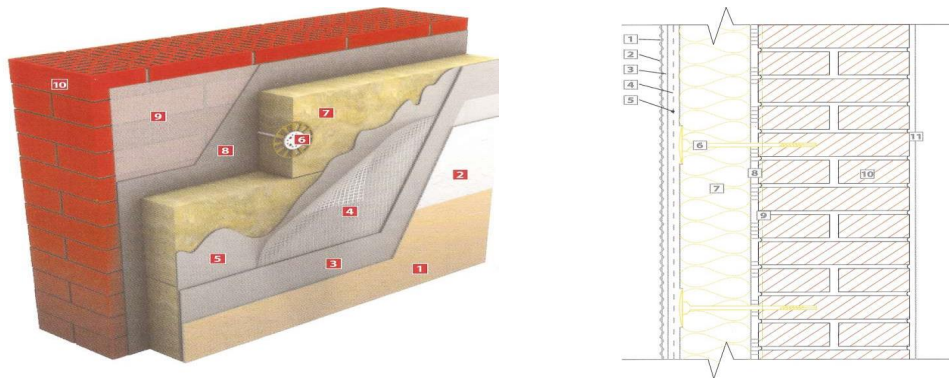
Система штукатурного фасаду з матеріалом-утеплювачем по кам'яній основі: 1 – фасадна фарба (за необхідністю); 2 – декоративна штукатурка; 3 – кварцева ґрунтівка; 4 – склотканева сітка; 5 – базовий армуючий шар; 6 – тарільчастий фасадний анкер; 7 – утеплювач; 8 – клей для теплоізоляційних робіт; 9 – зміцнююча ґрунтівка; 10 – зовнішня стіна
